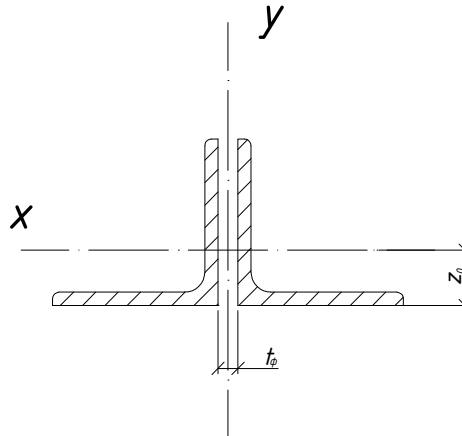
Схема перерізу поясів (дана або дзеркальна щодо осі “X”)
